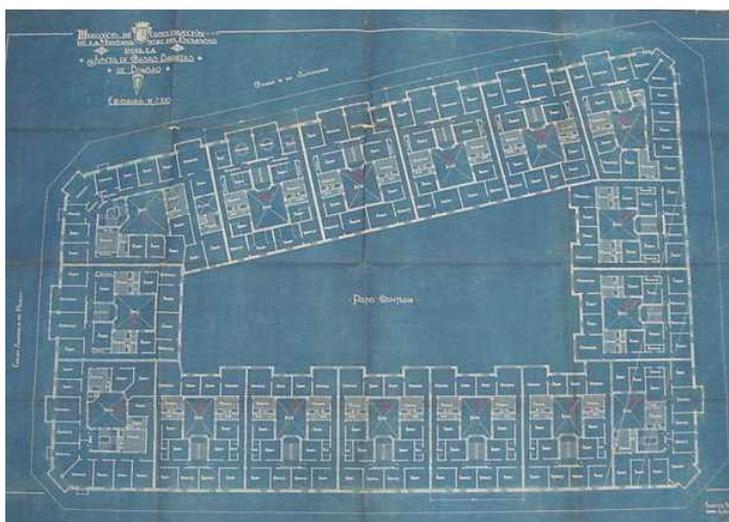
Planta general del proyecto de construcción de la manzana 39 del ensanche bilbaíno (1923)
